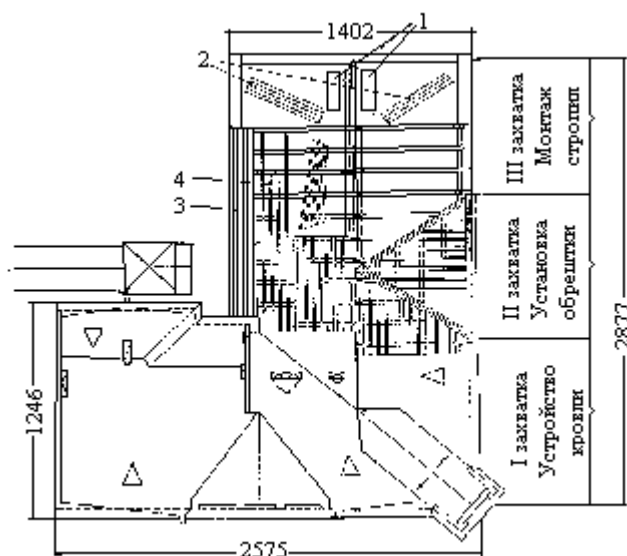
Схема организации работ по устройству стропильной системы из бревен с обрешеткой из брусков
